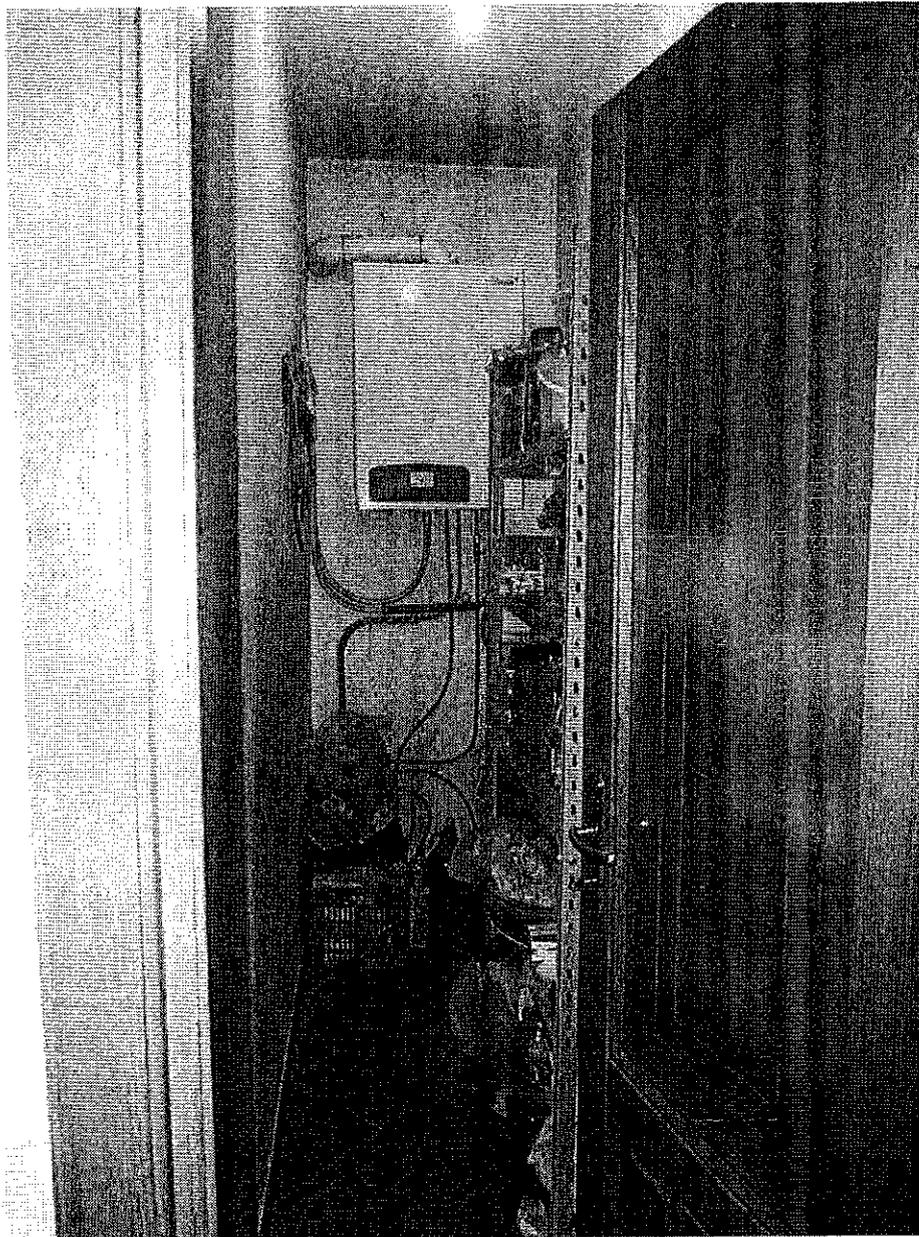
< Piccola dispensa a servizio della zona giorno >
